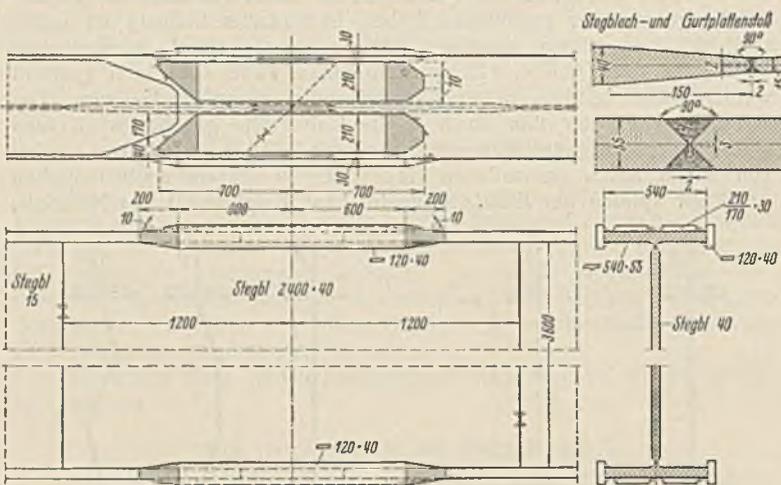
Stoßausbildung der Eisenbahnbrücke Anteil Doernen.
